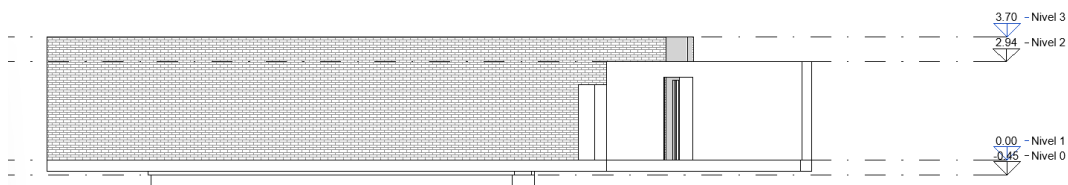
Alzado Norte modelo levantamiento con SLAM. Fuente: elaboración propia.
